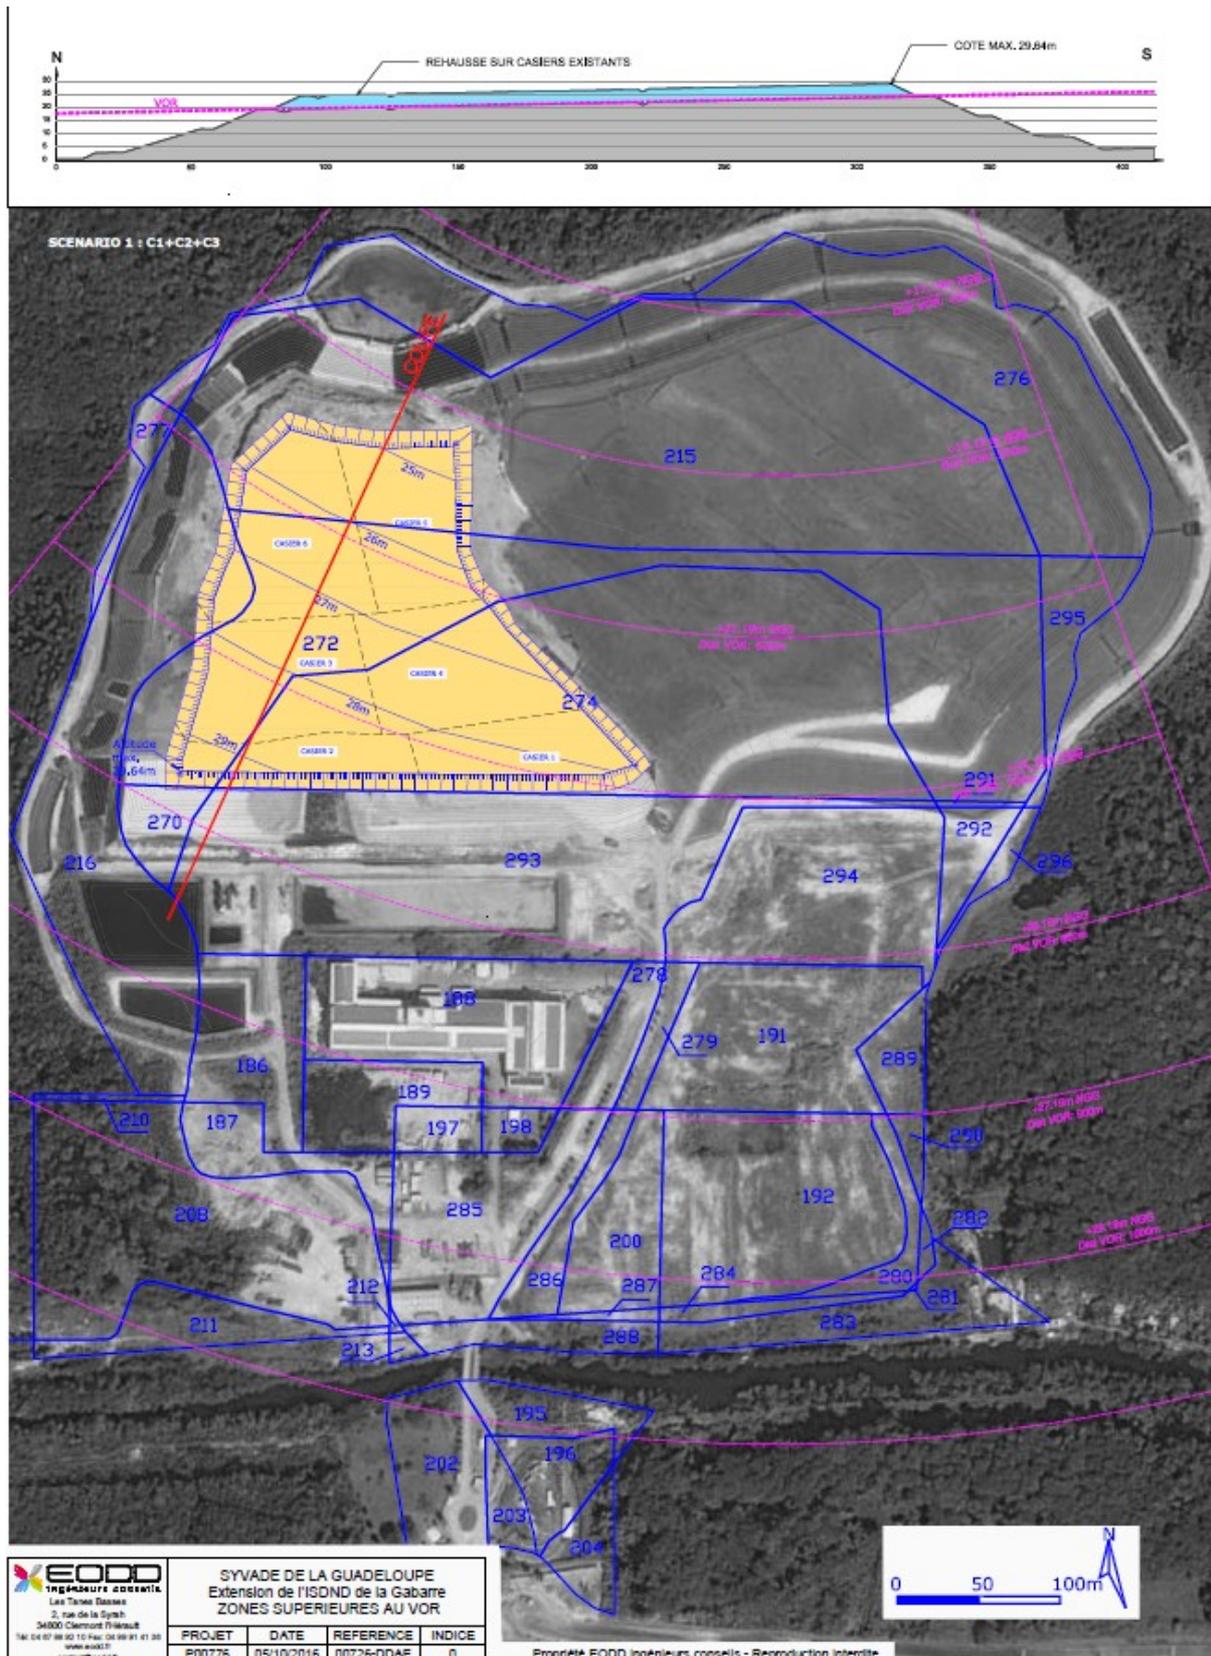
Plan des niveaux maximums de constructions lié à la présence du VOR
